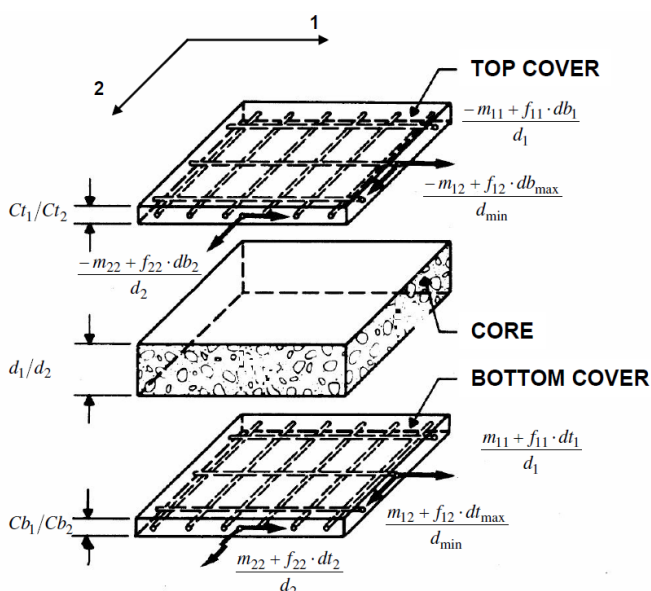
Fuerzas de membrana en las distintas capas en las que se divide el elemento tipo losa (Sandwich Model)
